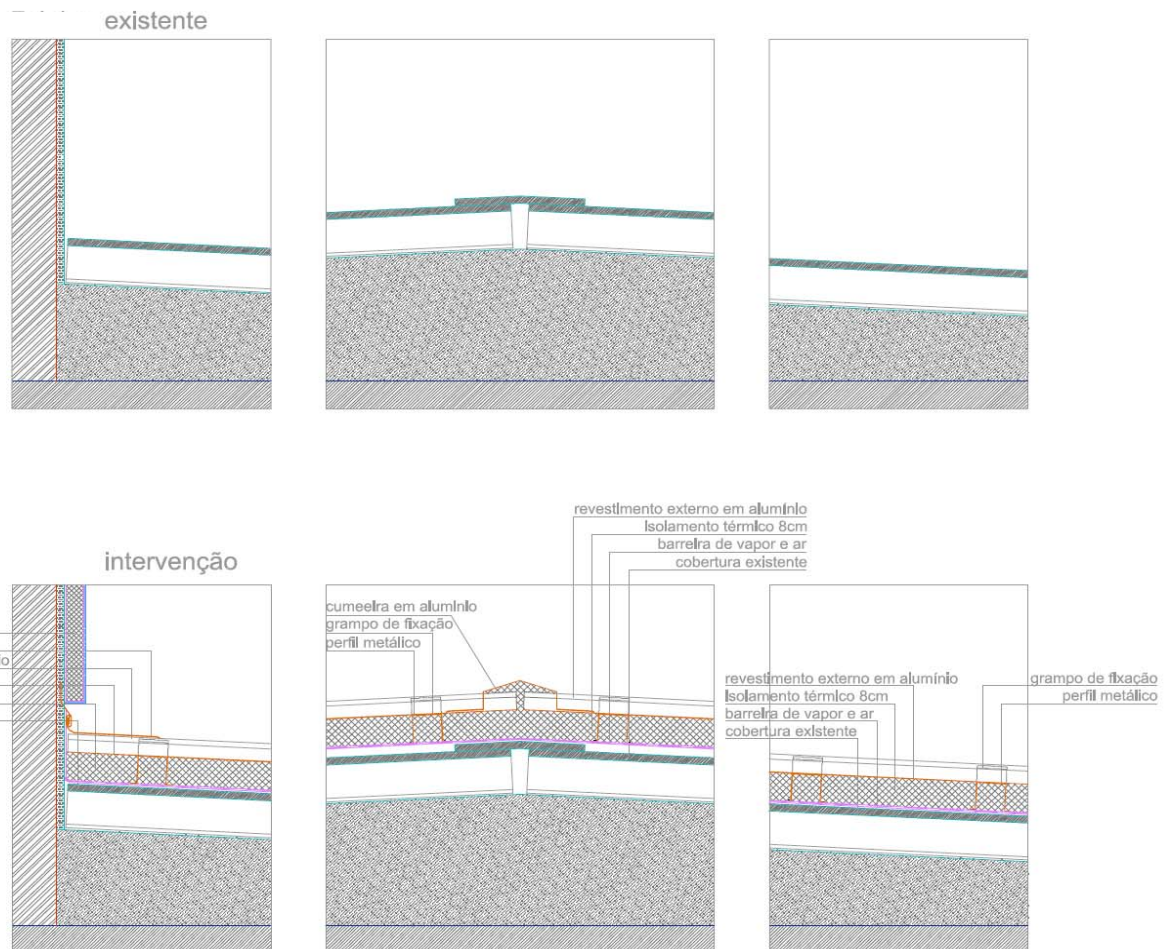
Cumeira. Pormenores construtivos da cobertura. (escala 1/20).
